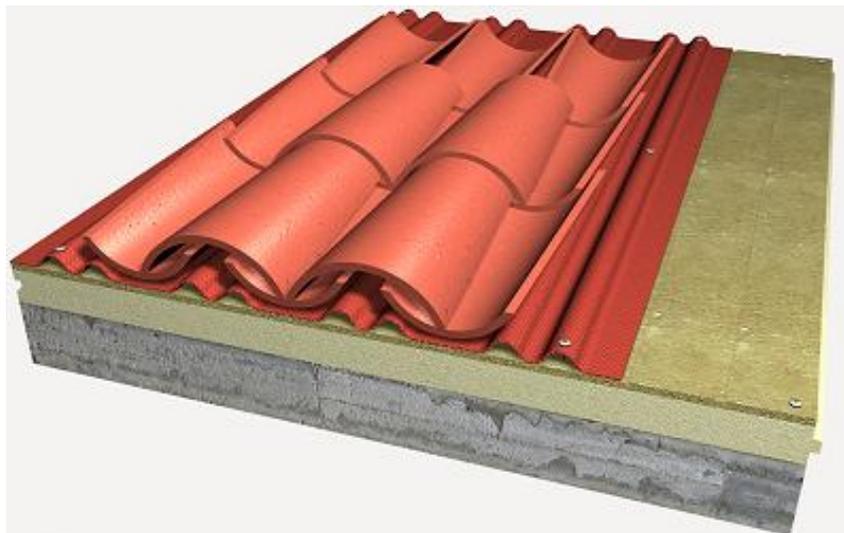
Sistema de aislamiento con lámina impermeabilizante cubierta por teja cerámica curva. (Fuente: generador de precios de cype)
